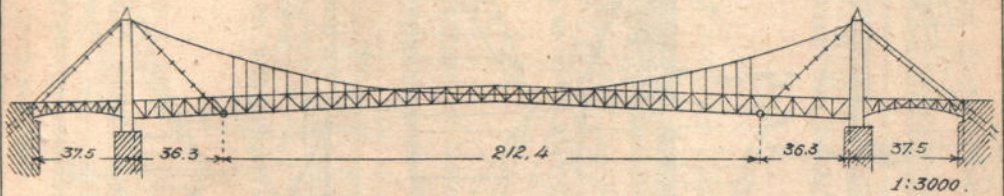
Неразрезные 3<sup>я</sup> пролет. фермы на качающихся колоннах.
